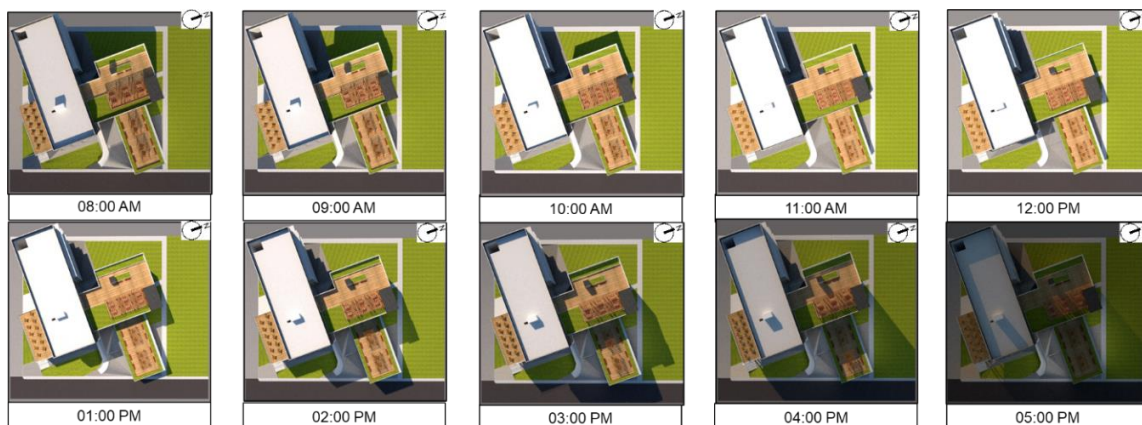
Vista en planta del recorrido solar en equinoccio de primavera.
